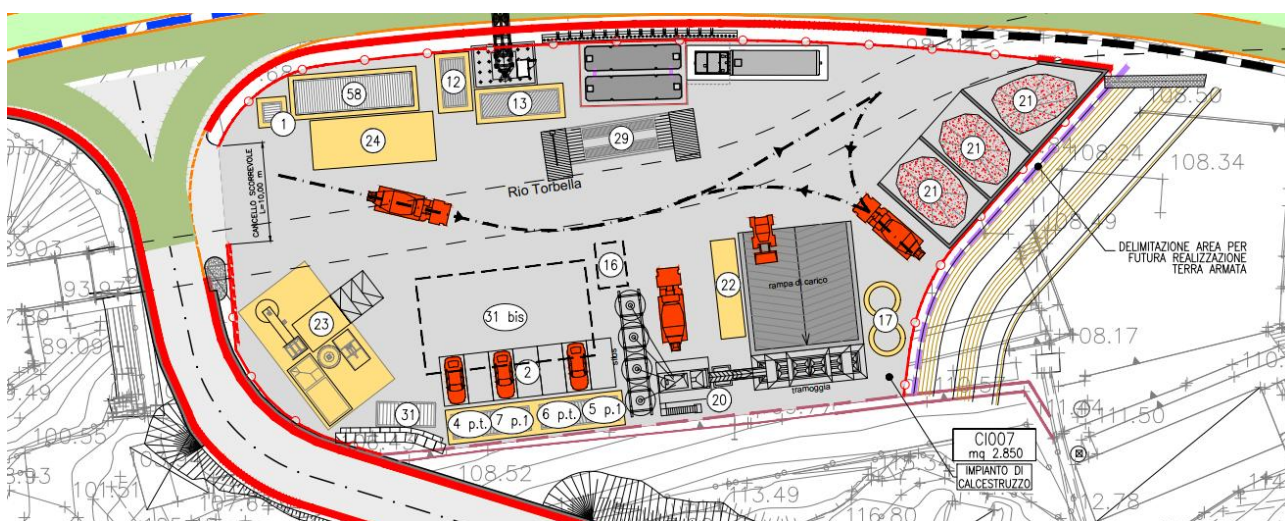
Layout del campo CI007 – apprestamenti di cantiere di prima fase
